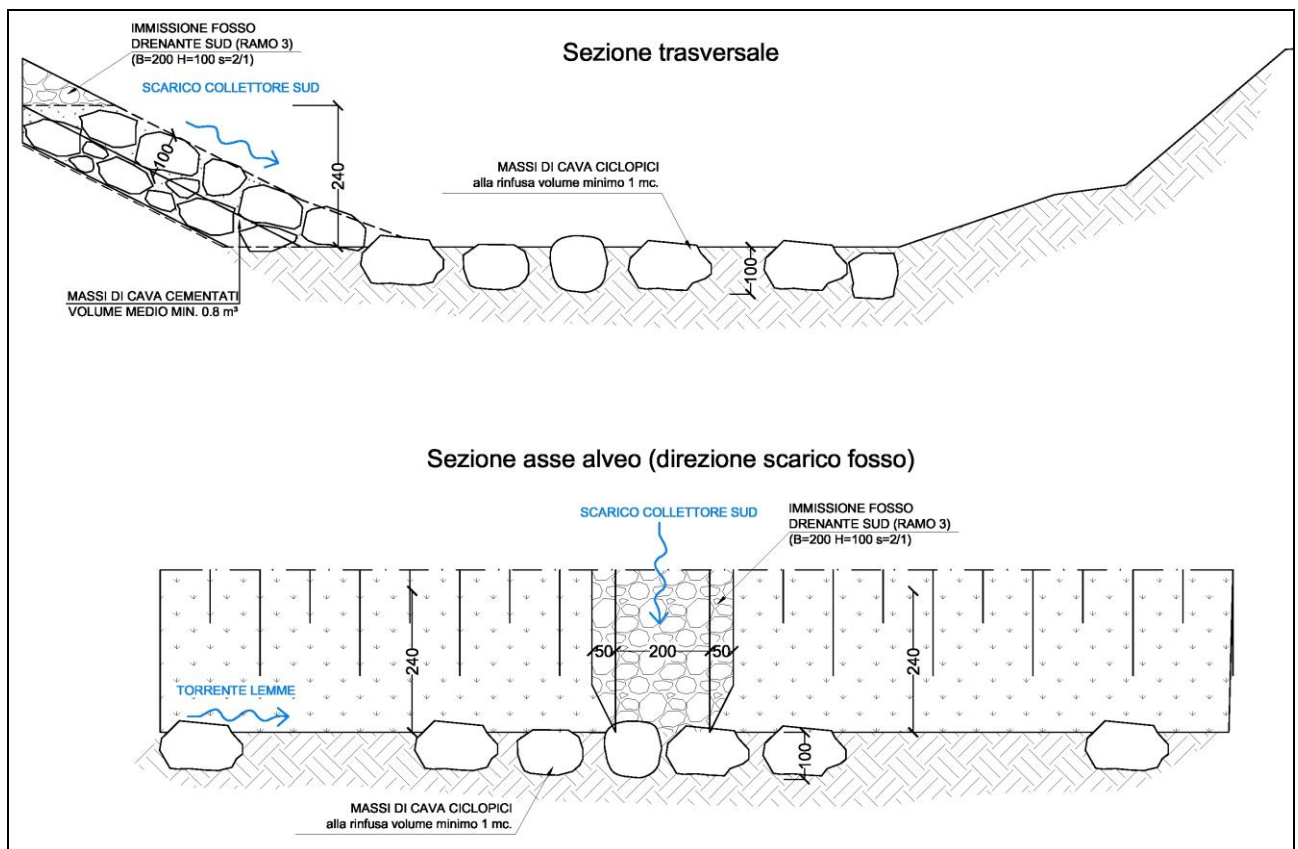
Sezione trasversale (sopra) e longitudinale (sotto) t. Lemme, in corrispondenza dello scarico Fosso drenante sud
